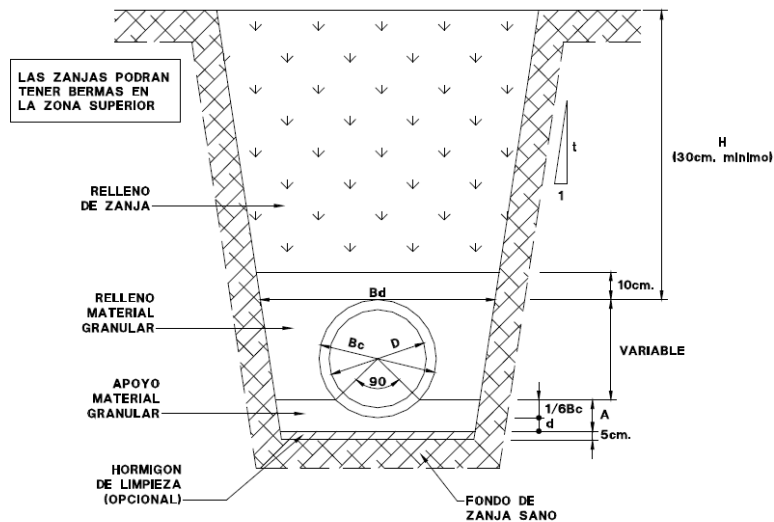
Sistema de instalación tubería de PVC saneamiento
